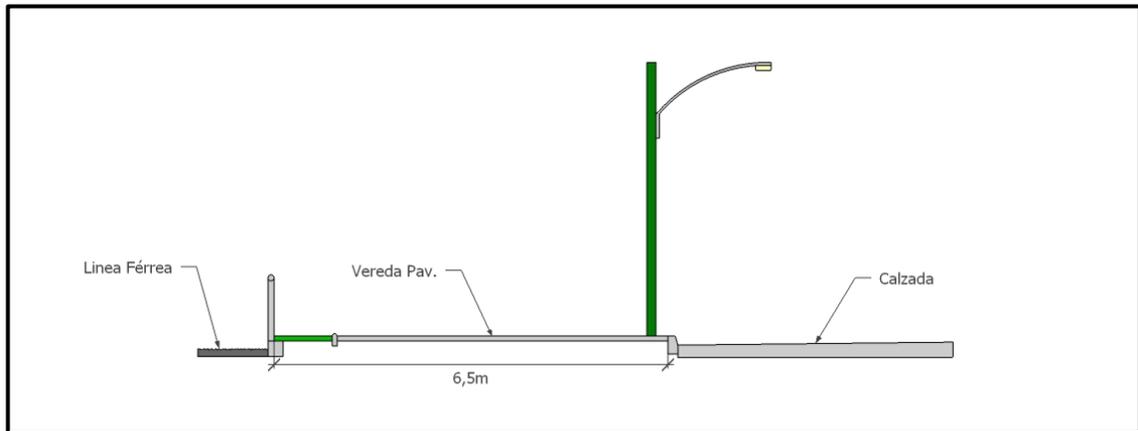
Perfil Transversal Eje A (Av. España) / Sector A1 / 3
